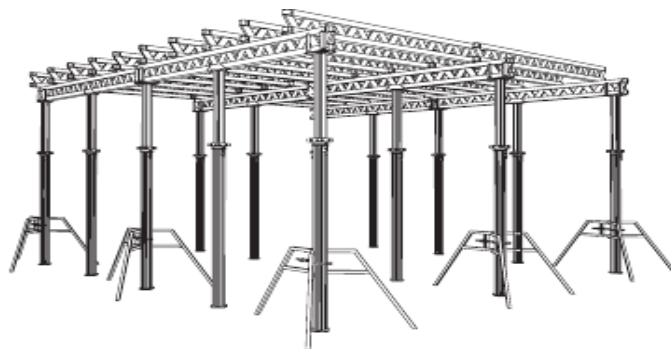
Бетонирование перекрытий с применением балочной опалубки перекрытий «PERIMultiflex»
